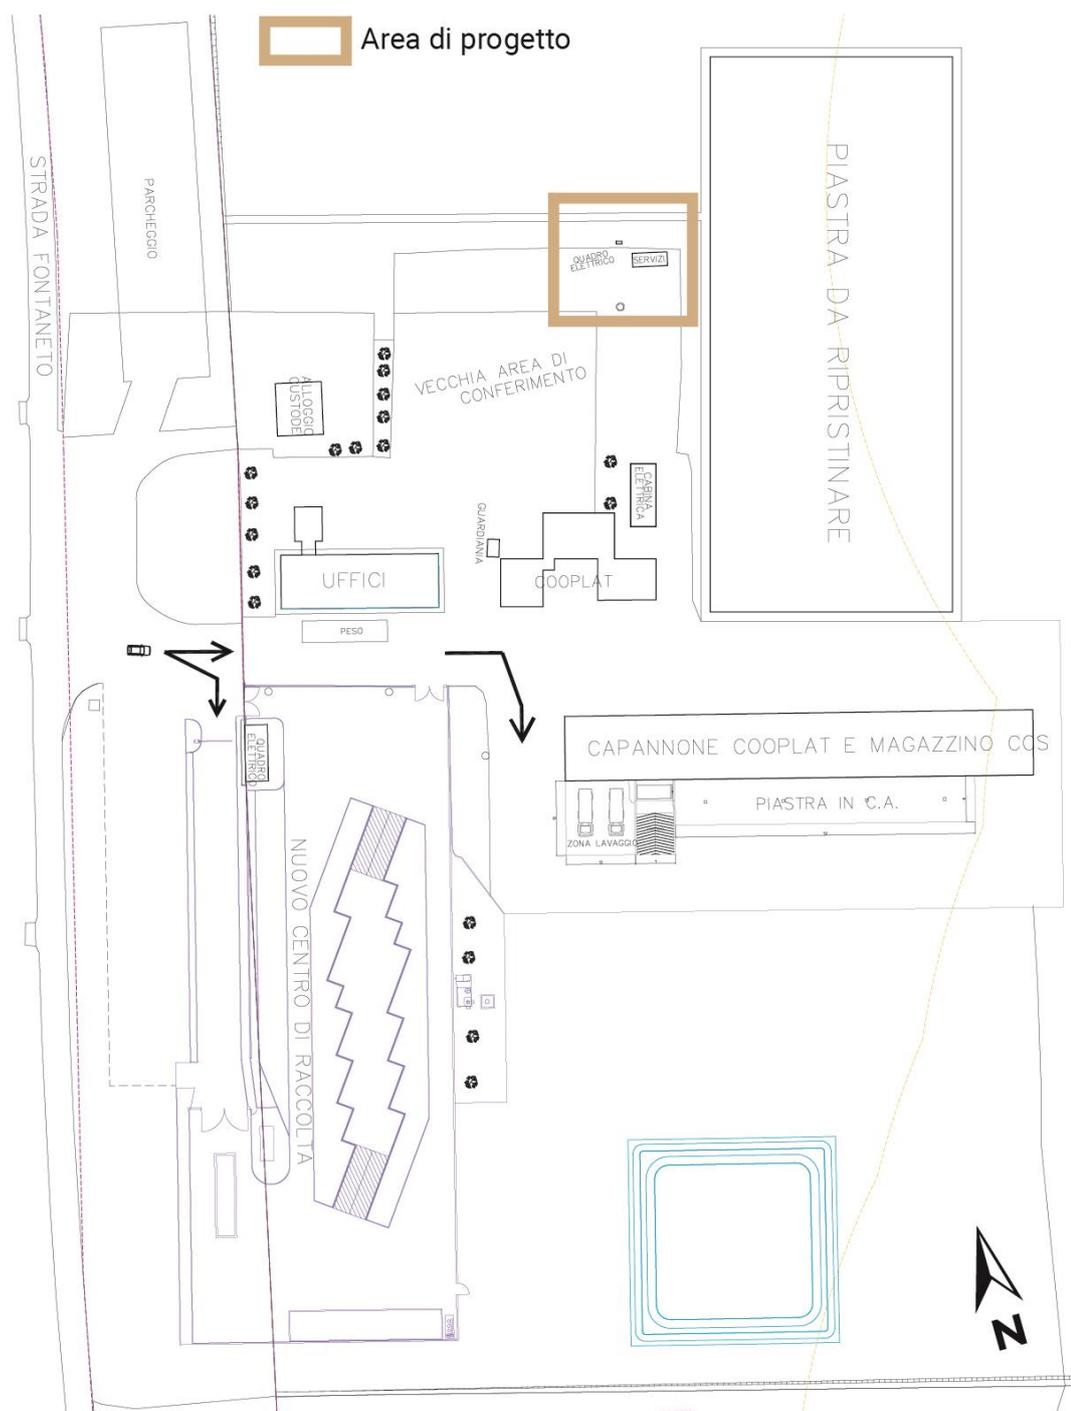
Planimetria generale del Centro di Raccolta di Chieri con indicazione dell'area di progetto.
